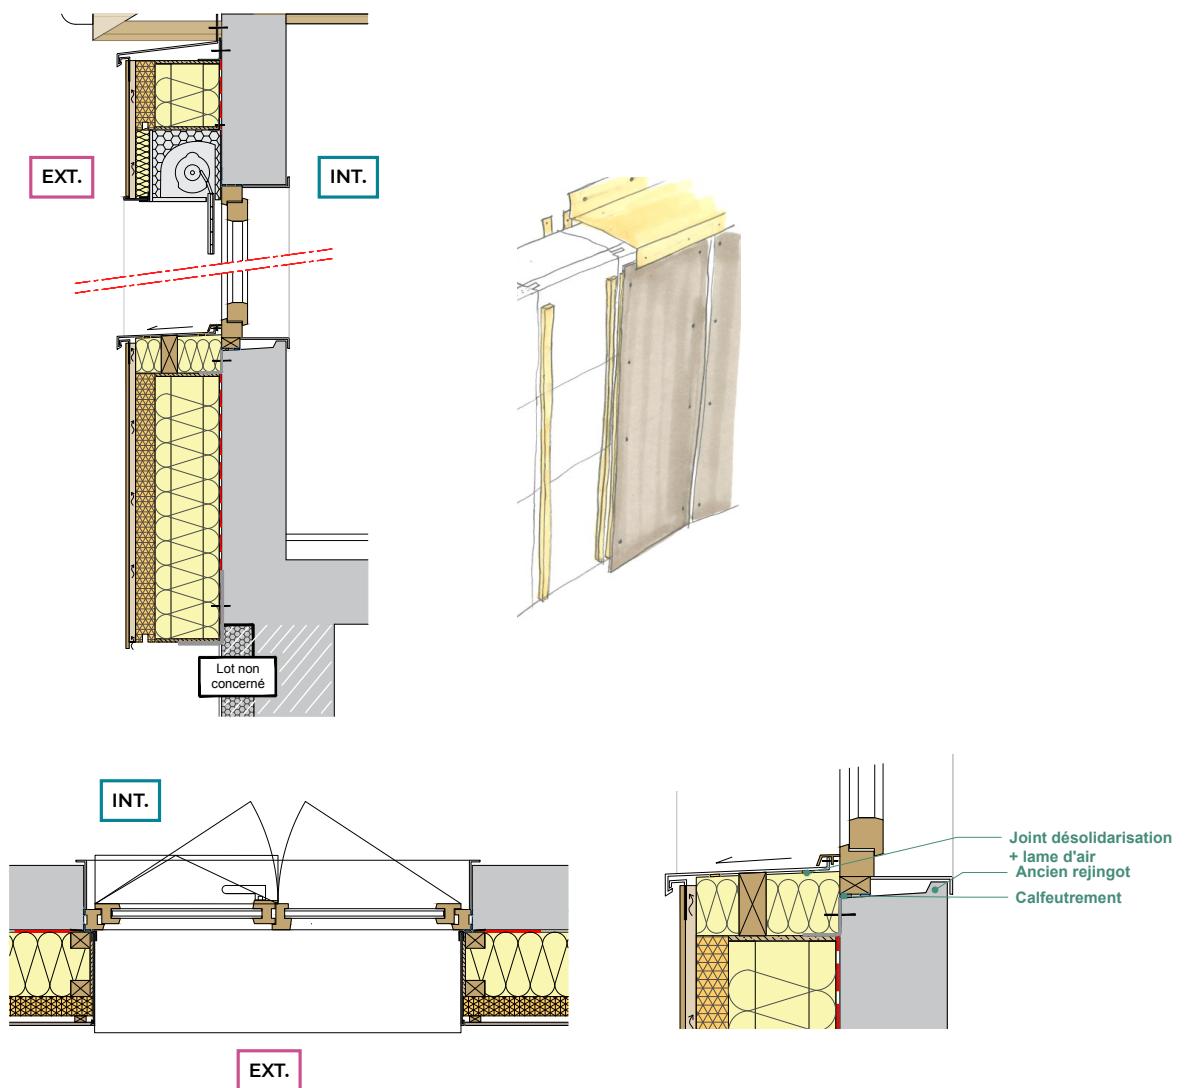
| Équerre de protection et anti-déversement des caissons, bavette, jambage...
